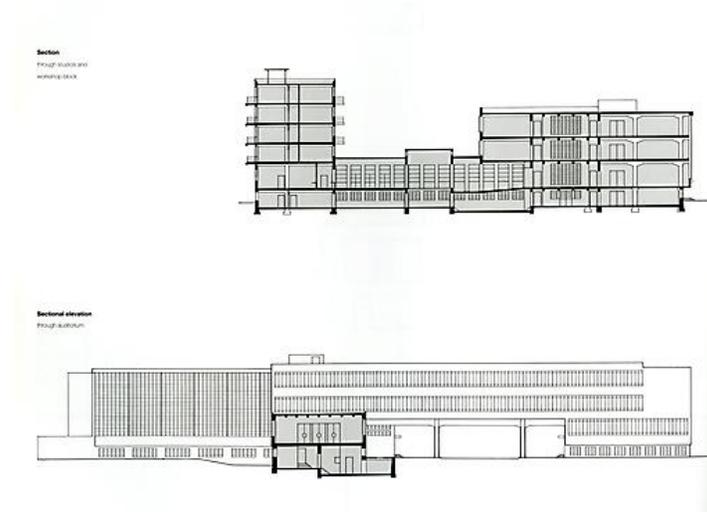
, Sección transversal y Elevación Longitudinal de la Bauhaus. Plataforma Arquitectura. 2018
